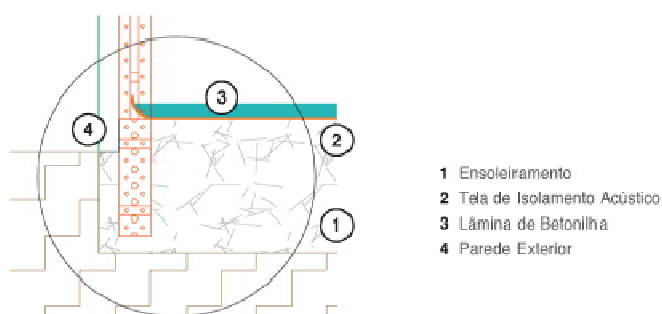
Pormenor de ligação da estrutura ao ensoleiramento (TÉKETO, 2010)
